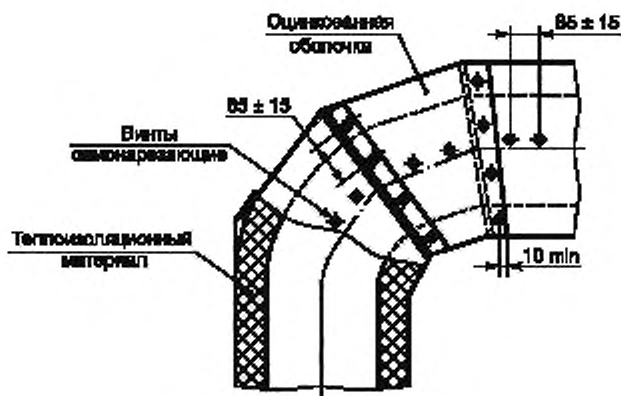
Конструкция СДТ в теплоизоляции
